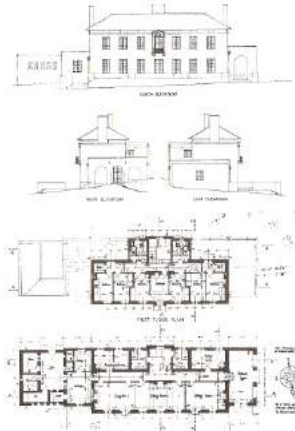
Plantas y alzados de la Guest House, en Ríotinto (Archivo de los autores).
